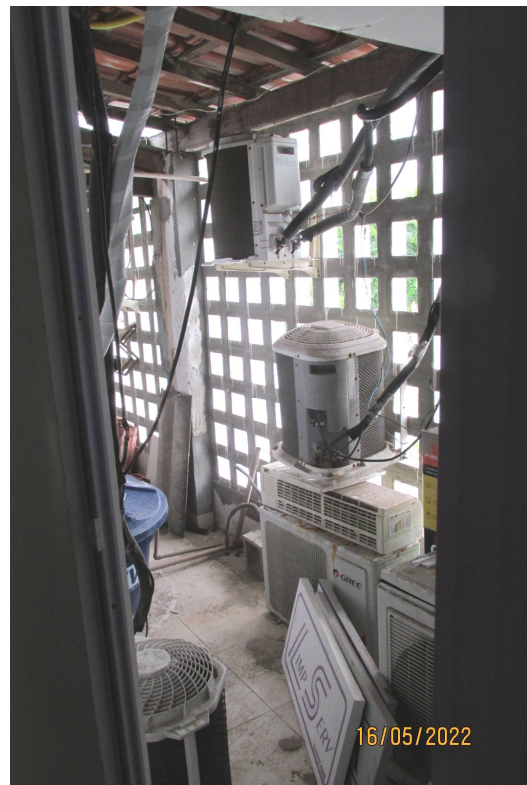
Vista de dependência existente ao lado da área técnica anterior; esta, já no interior da área titulada. Observar acabamento de piso, paredes e teto.
